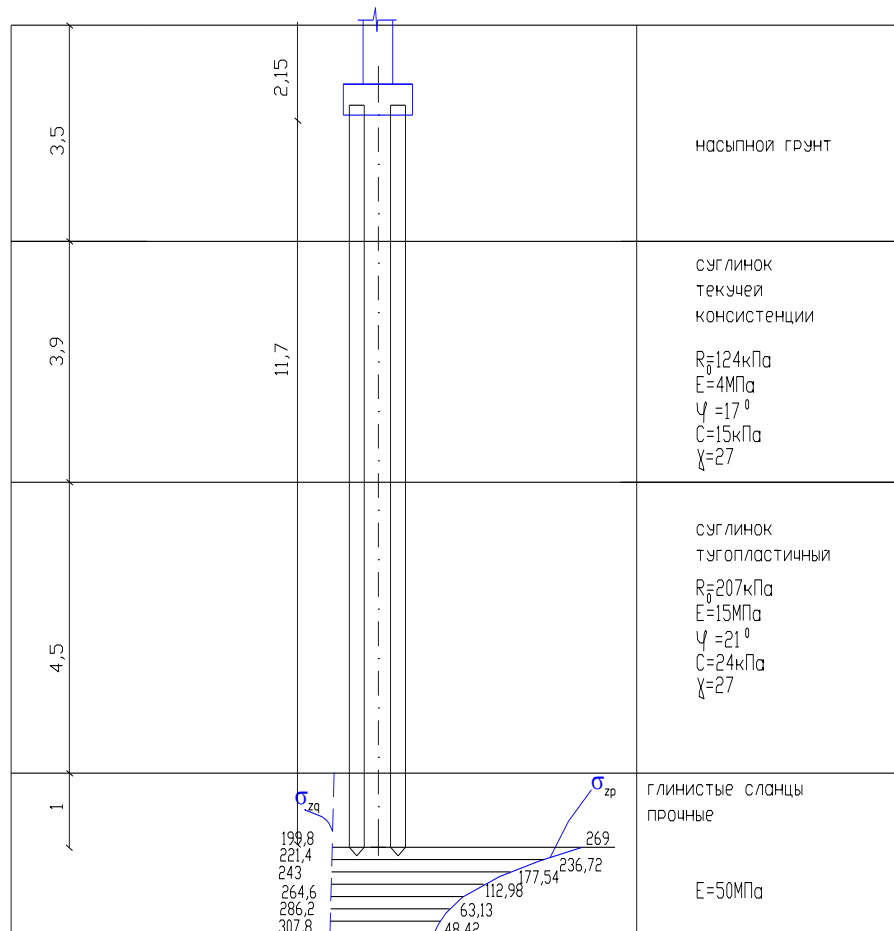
Схема до розрахунку осадки стрічкового фундаменту палі
